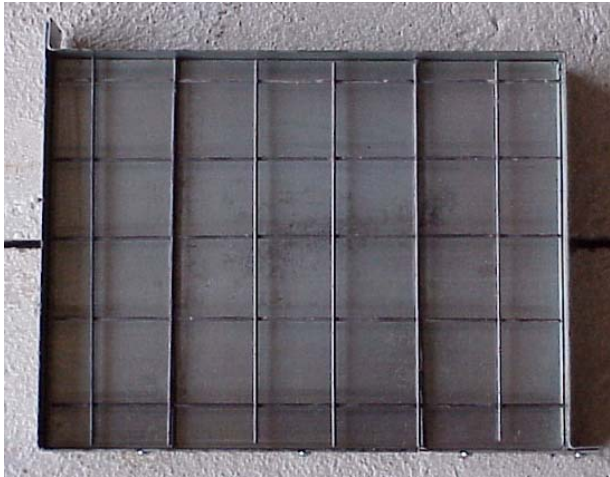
Önüretimli Panel Detayı, Tip-2
